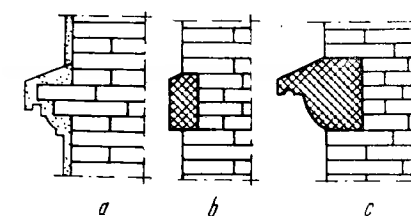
Exemple de briie: a - din zidărie tencuită; b; c - din piatră naturală sau beton.
